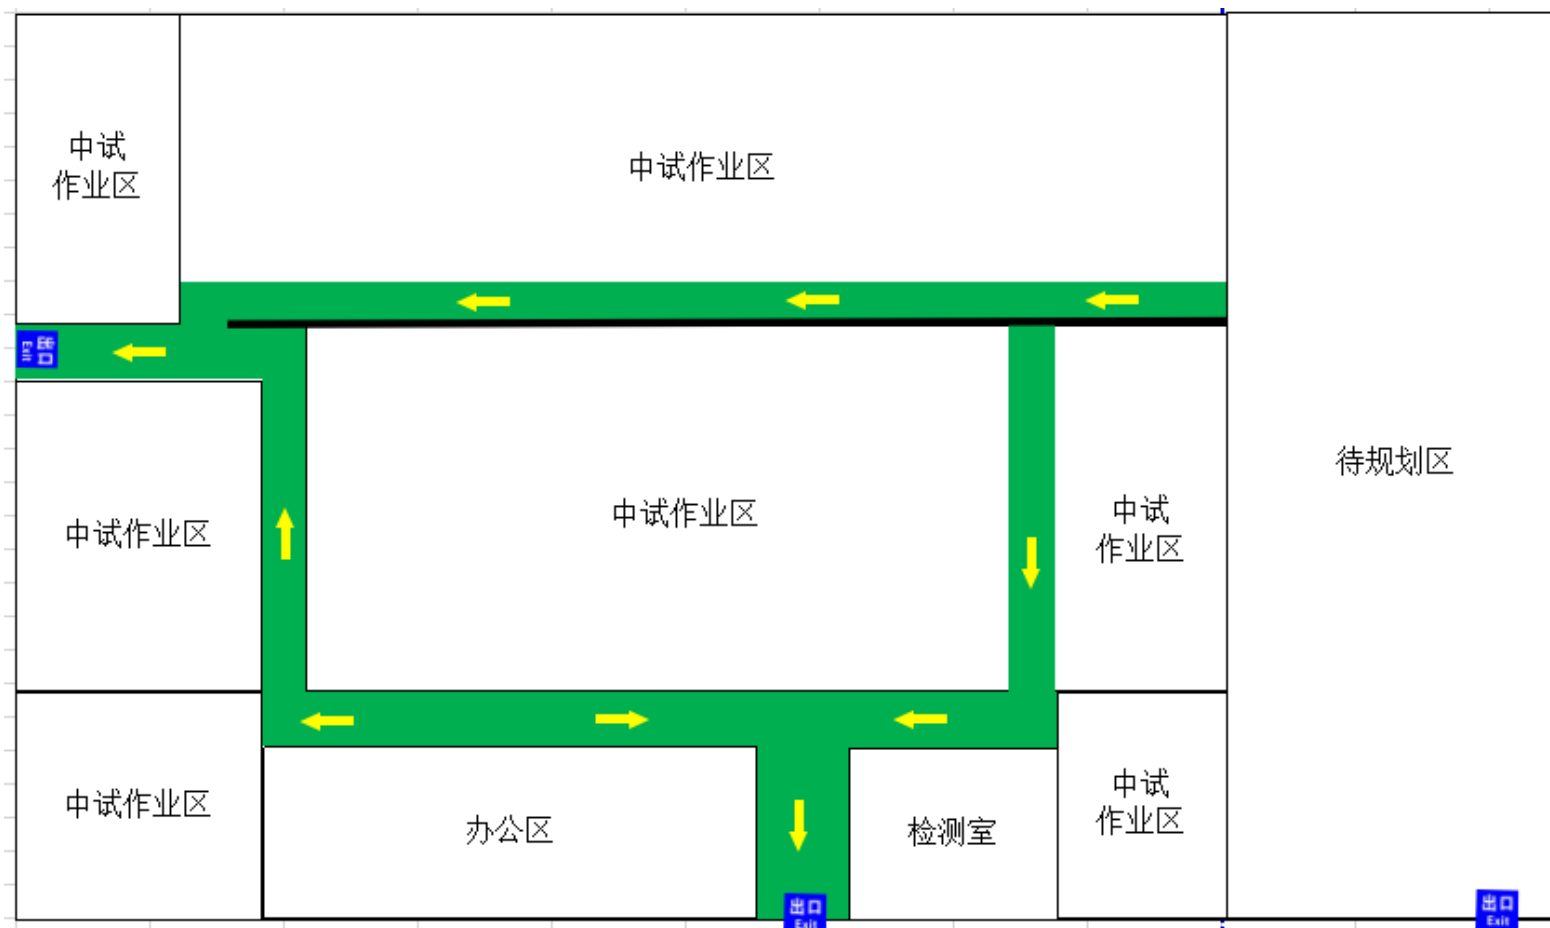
项目工程23号厂房（研发中心）平面布置图
